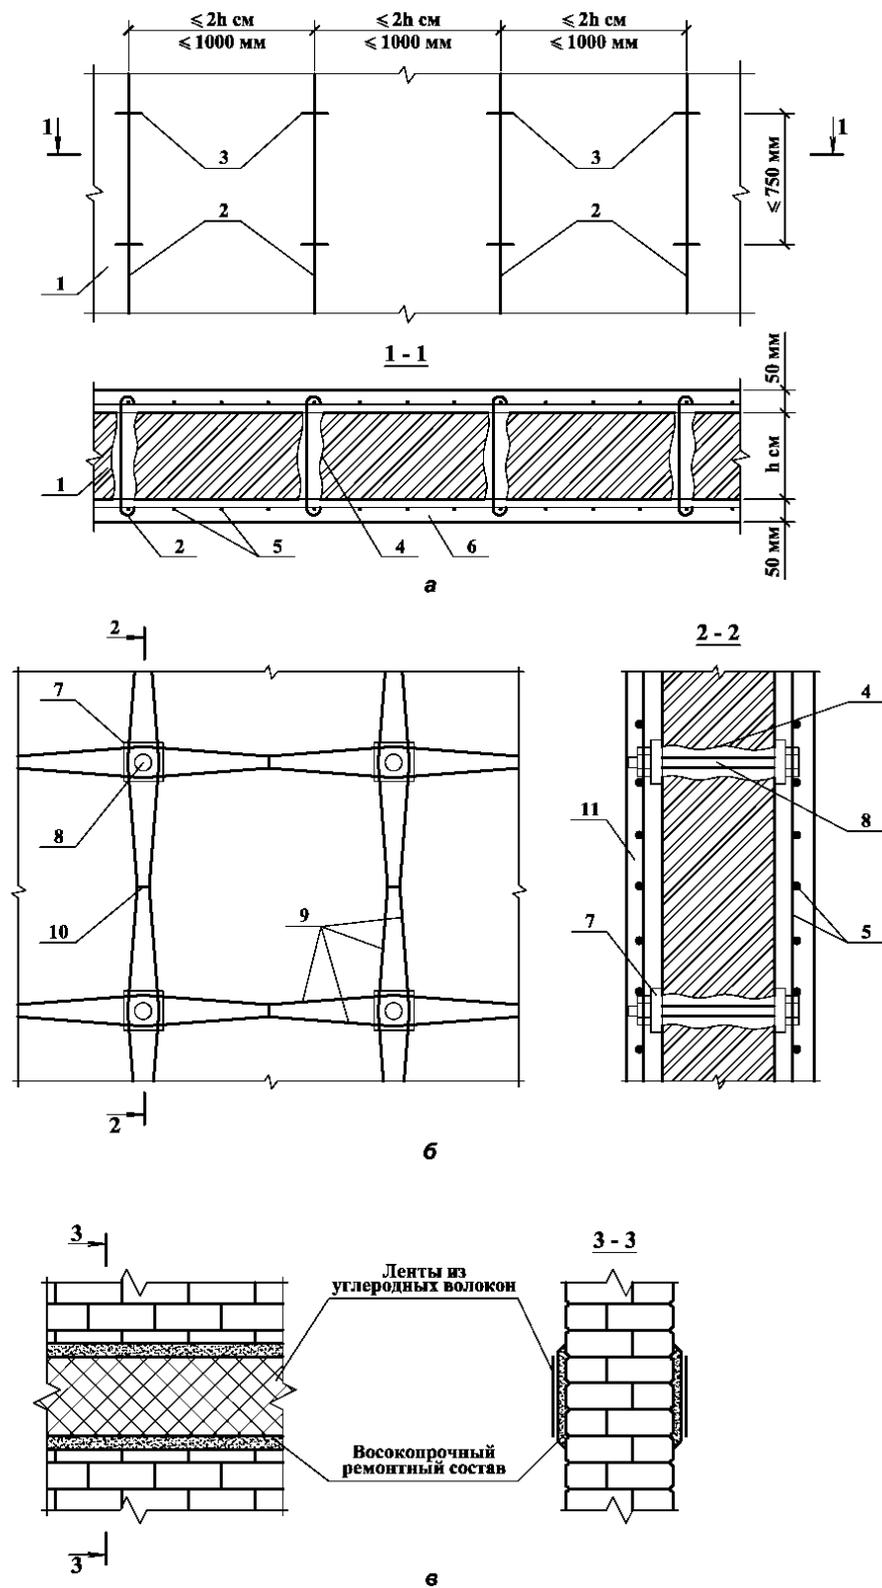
Усиление стен обоями: а – железобетонной; б – штукатурной предварительно-напряженной; 1 – усиливаемая стена; 2 – арматурные стержни $\text{Ø}10\text{--}14 \text{ мм}$; 3 – хомуты-связи $\text{Ø}10 \text{ мм}$; 4 – отверстия в стене; 5 – арматурные сетки, привязанные к арматурным
